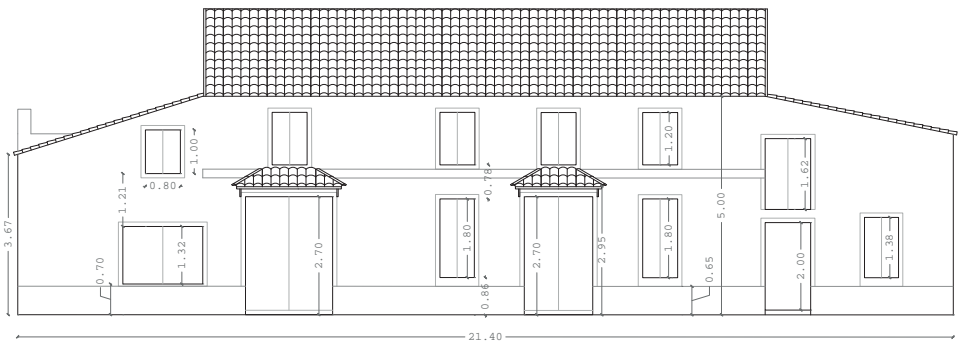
a: Alzado Alquería Diego. Planimetría escalada en el anejo 1.
